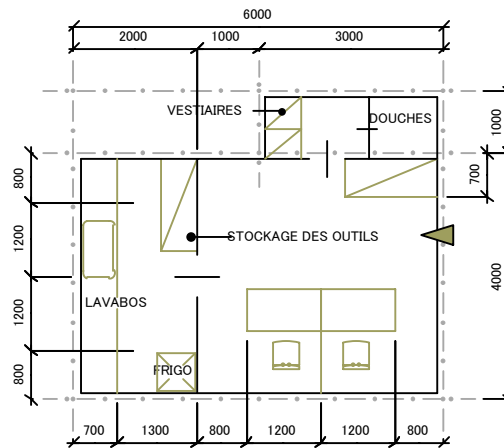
Plan planimétrique du bureau de contrôle sanitaire
